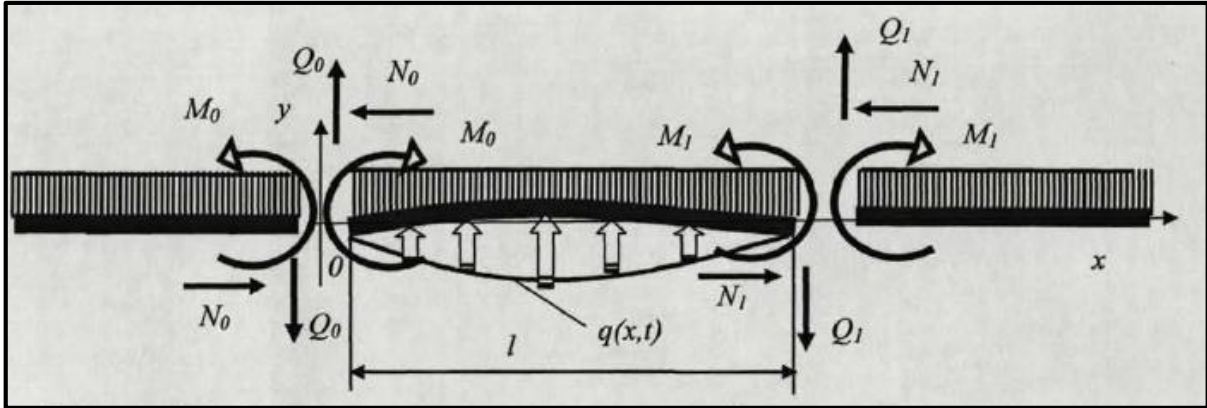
Расчетная схема подземного трубопровода при поперечных подвижках грунта в процессе землетрясения
